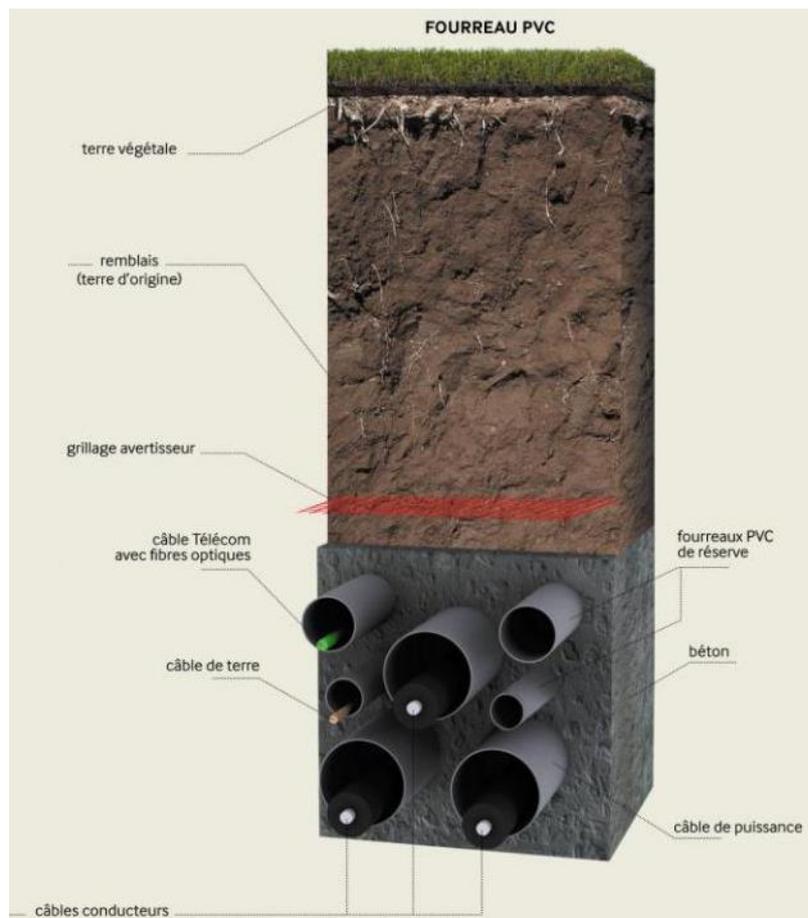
Coupe type d'une liaison souterraine à 1 circuit posée en fourreaux PVC enrobés de béton
